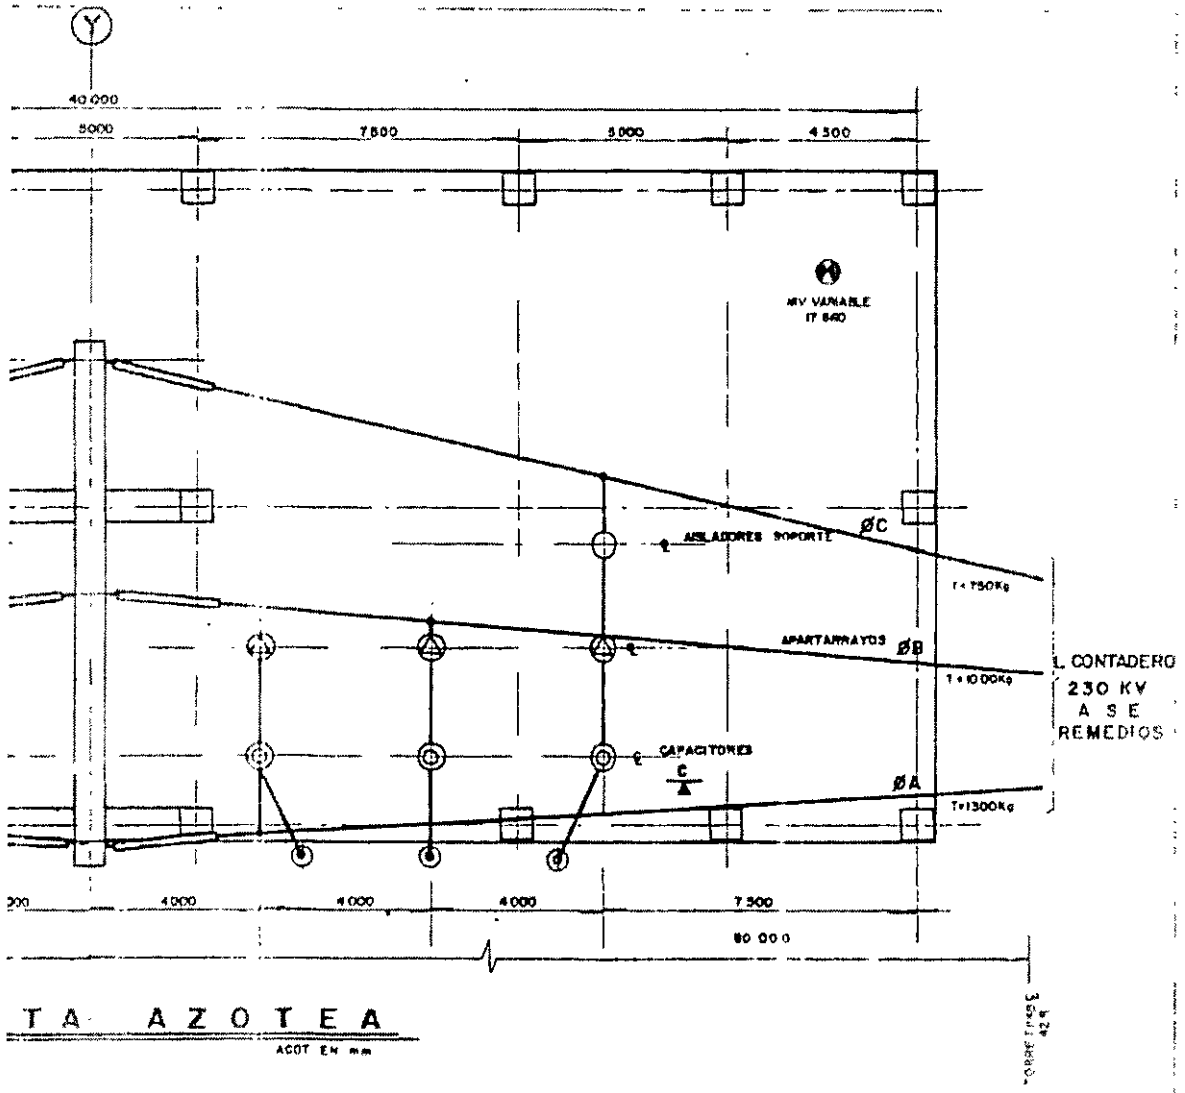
A S.E. Contadero 230/23 kV, SF₆, Planta Azotea
